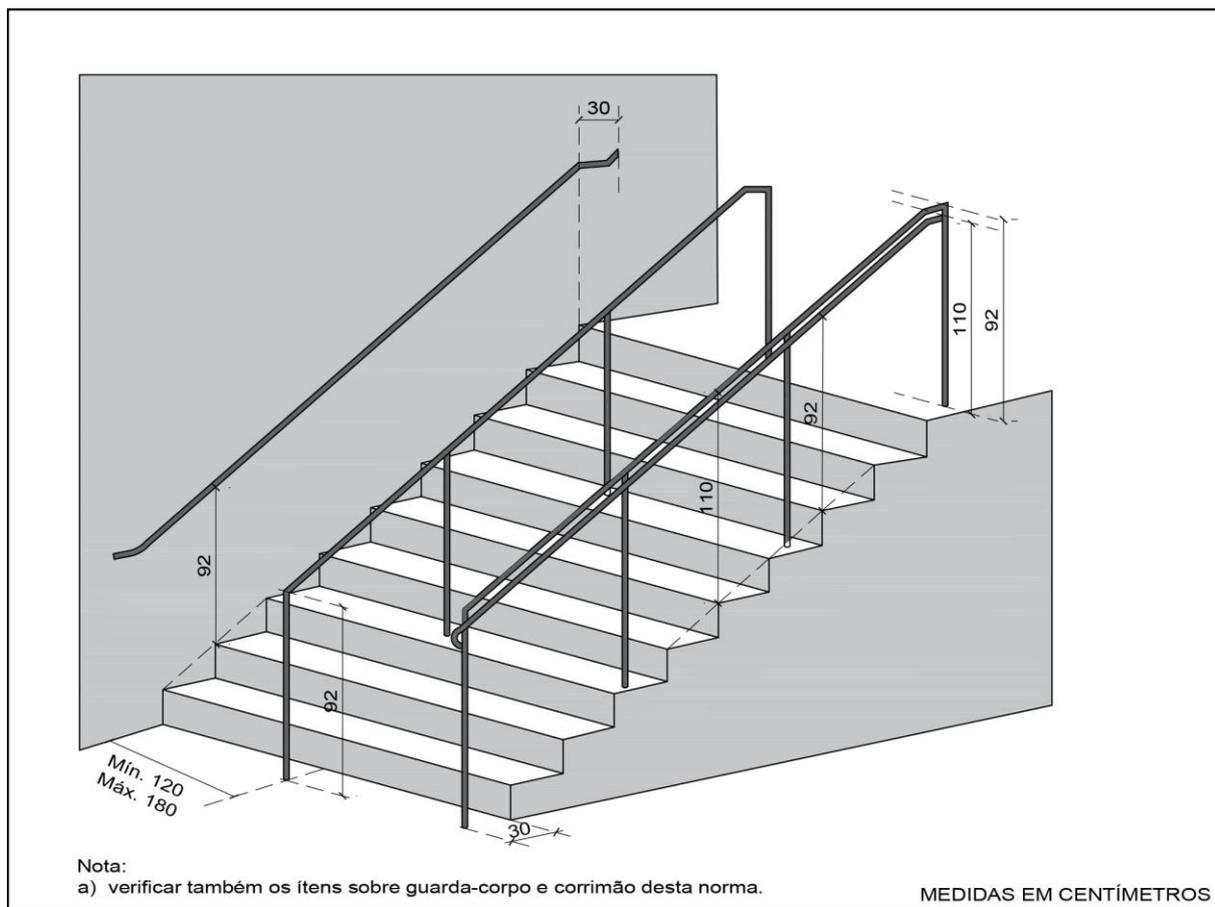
Barreiras, guarda-corpos e corrimãos centrais: cargas de projeto, alturas e disposições
